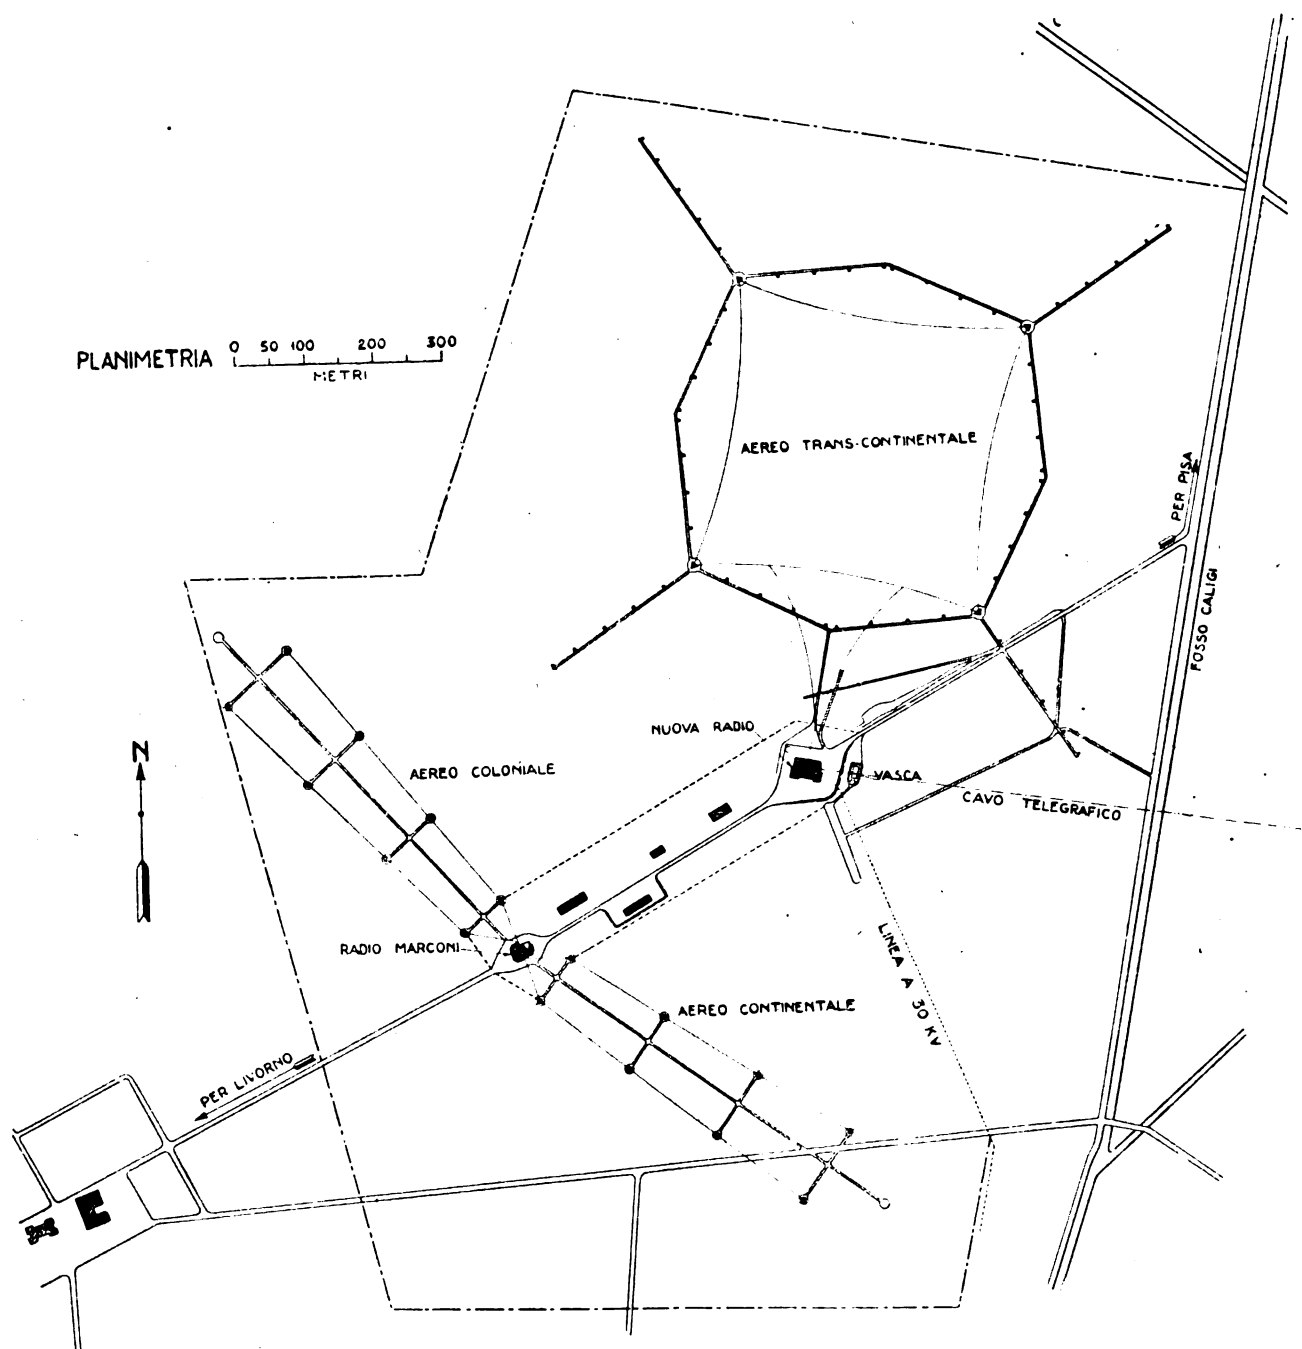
Pianta generale del centro radiotelegrafico di Coltano.
